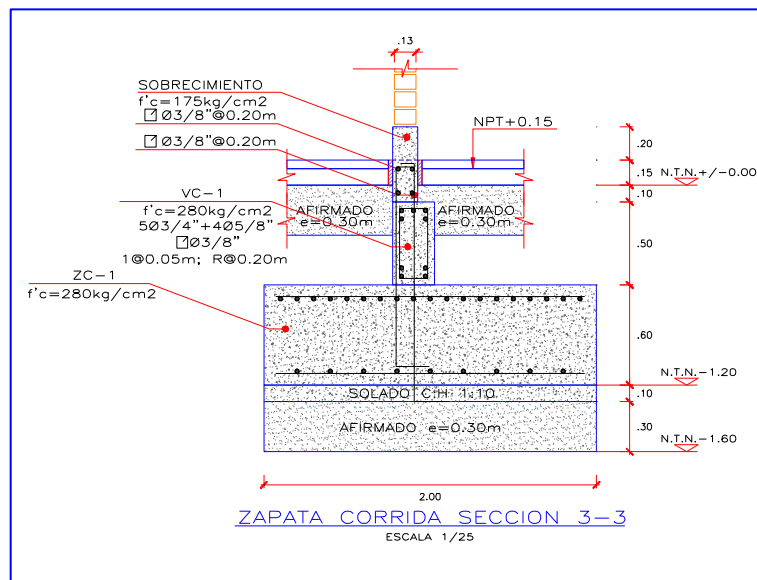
Sección 3-3 de Zapata Corrida ZC-1
